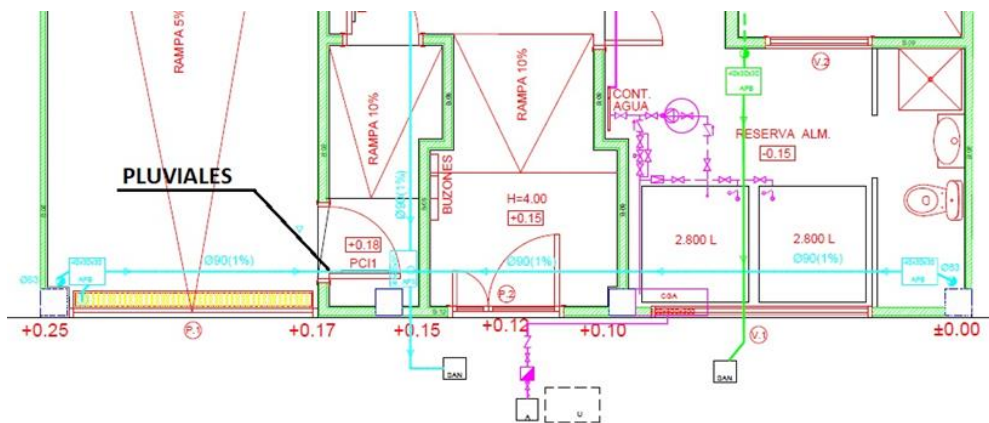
Situación original de las instalaciones, planta de sótano. Fuente: Proyecto original.
